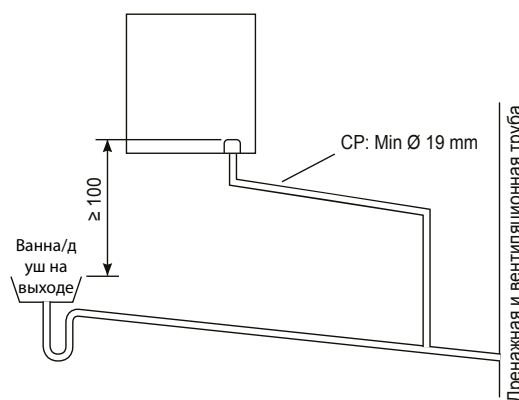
Подсоединение дренажной трубы для конденсата к сливу в ванной на нижнем уровне
